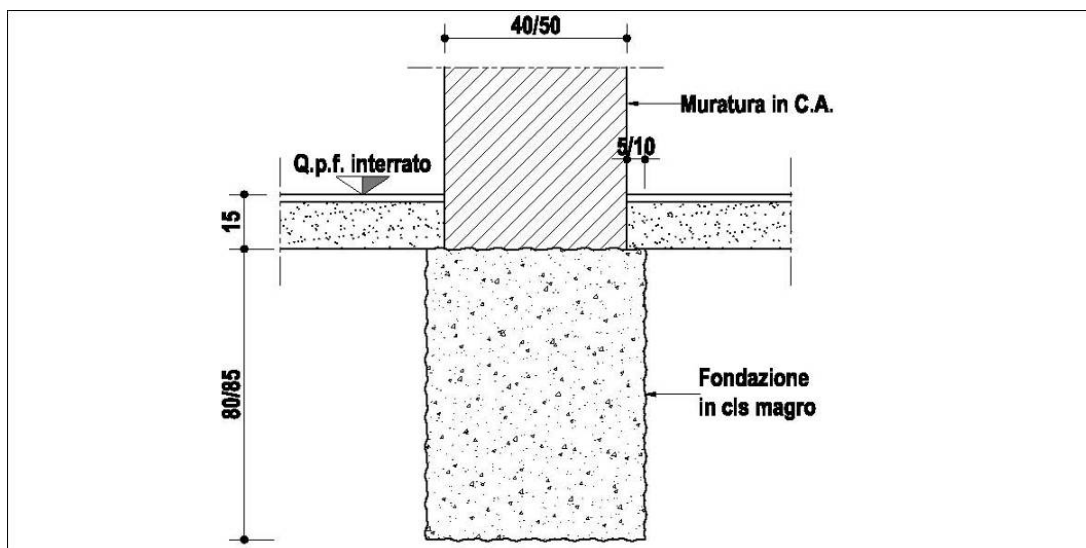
Fondazioni – Edificio interno edificato anni '90
